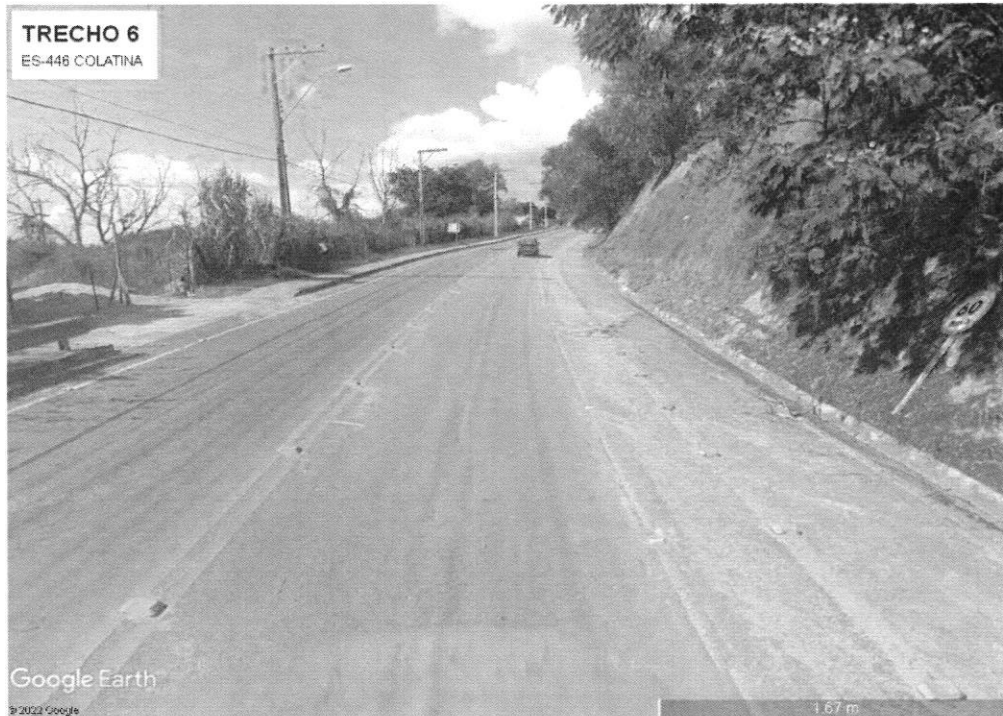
FOTO MOSTRANDO CONSTRUÇÕES, ILUMINAÇÃO PÚBLICA E CALÇADAS
